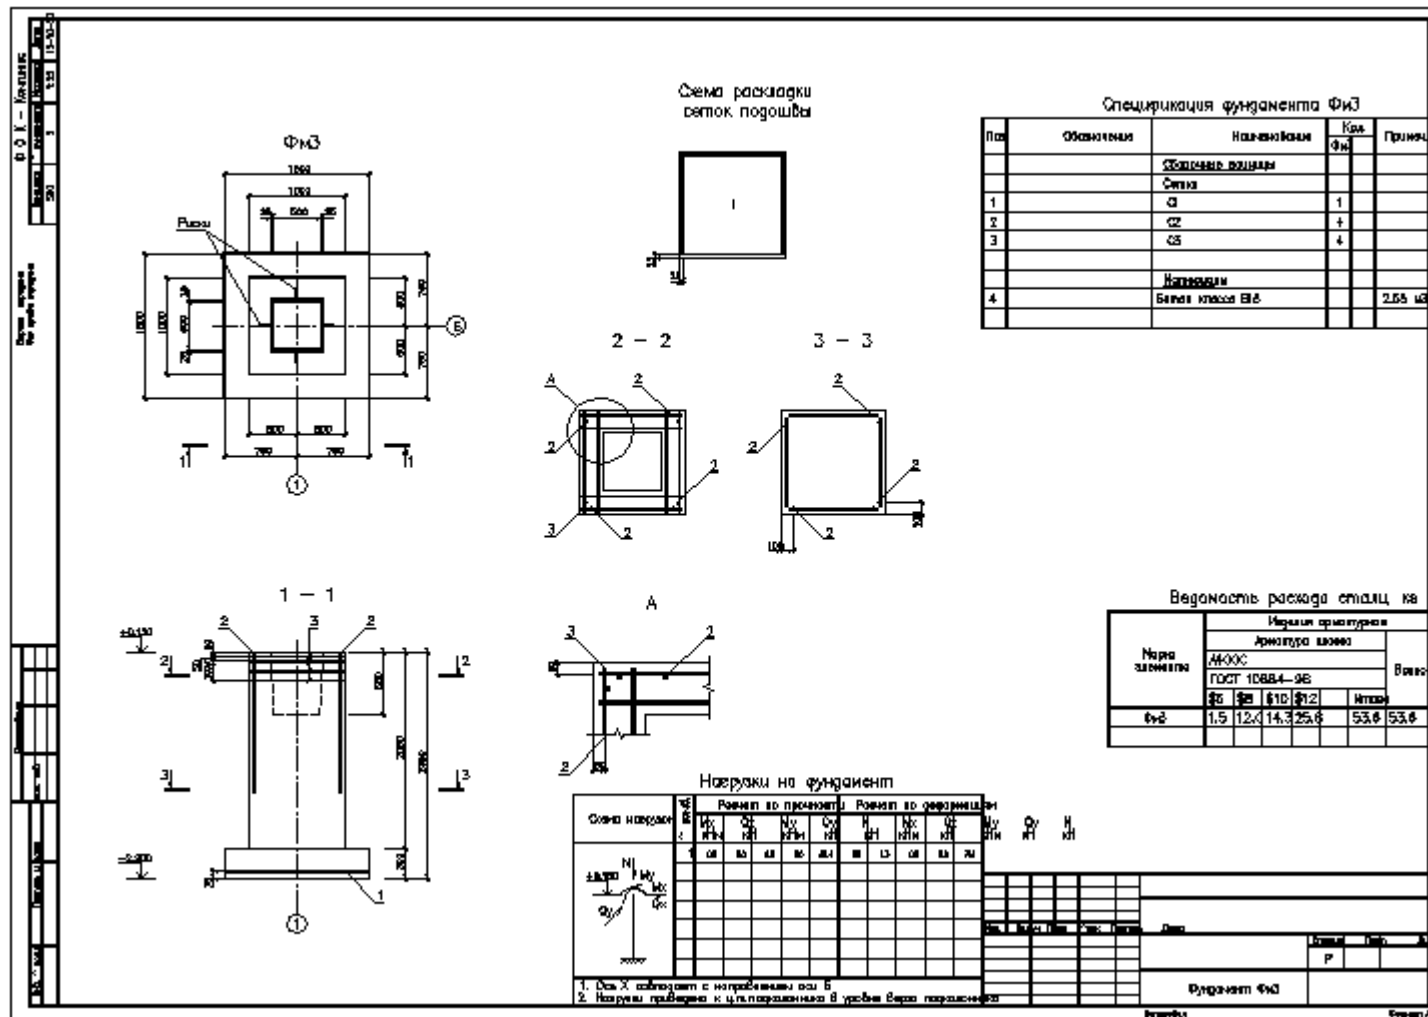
Фундамент ФМ3. Кресления рабочего проекта
